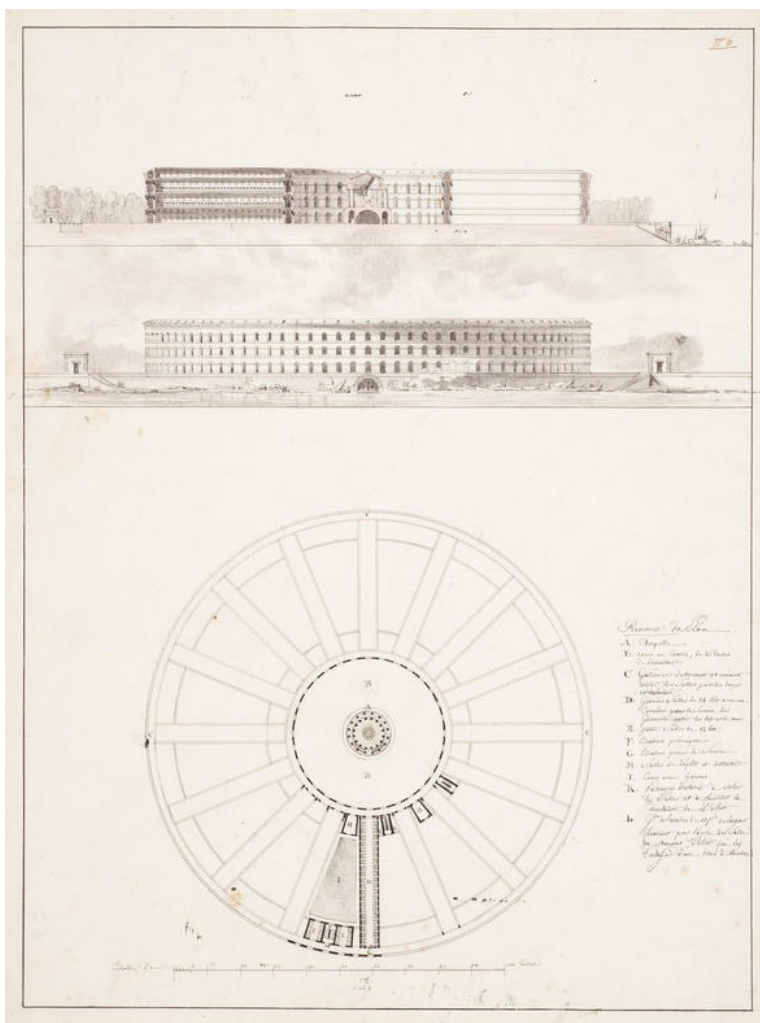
Planta y alzado del hospital diseñado por Poyet
